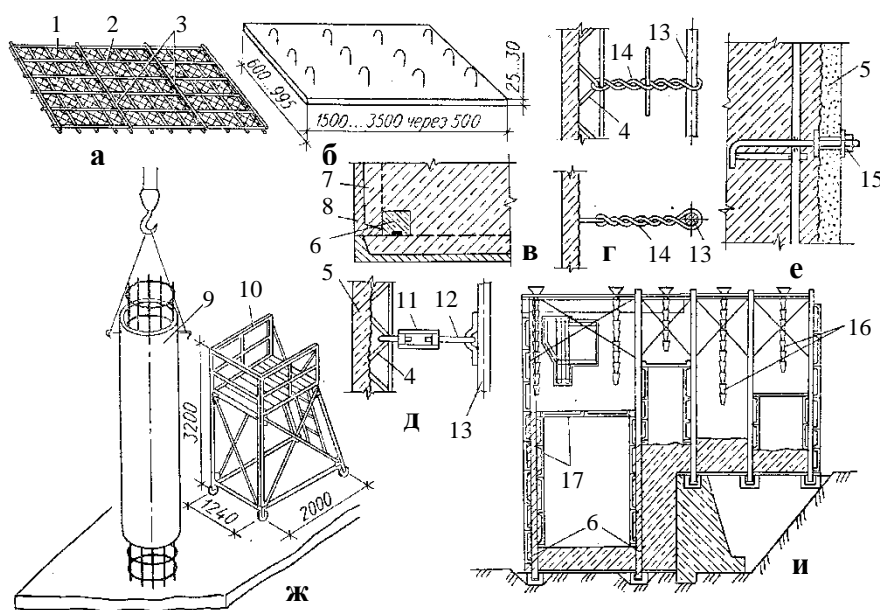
Схема опалубки-личкування: а – армопакет; б – плоска армоцементна плита опалубки-личкування; в – кріплення ребристих плит опалубки; г – кріплення плоских плит скрутками; д – кріплення плоских плит форкопфом; е – кріплення плоских плит через отвори в плиті; ж – опалубка колони з азбестоцементної труби; и – опалубка масивного фундаменту; 1 – тканина сітка; 2 – зварна сітка; 3 – притисні прутки; 4 – арматурна фермочка; 5 – плита; 6 – залізобетонний стояк каркаса; 7 – бетон конструкції; 8 – ребриста плита опалубки; 9 – азбестоцементна труба; 10 – монтажний стіл; 11 – форкопф; 12 – відрізок арматури; 13 – стрижень армокаркасу; 14 – скручування; 15 – болт з гайкою; 16 – ланкові хоботи; 17 – плити опалубки-личкування
